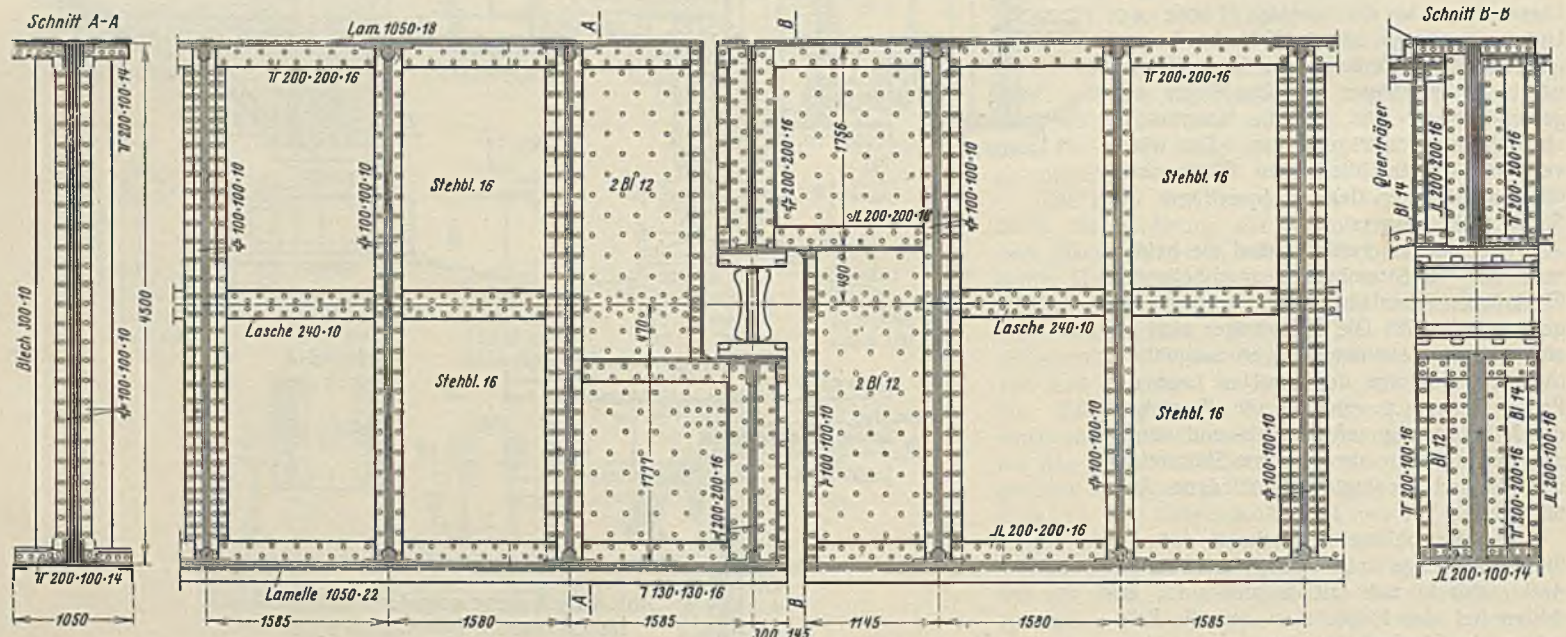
Hauptträger der Flutbrücke mit Gelenk.
